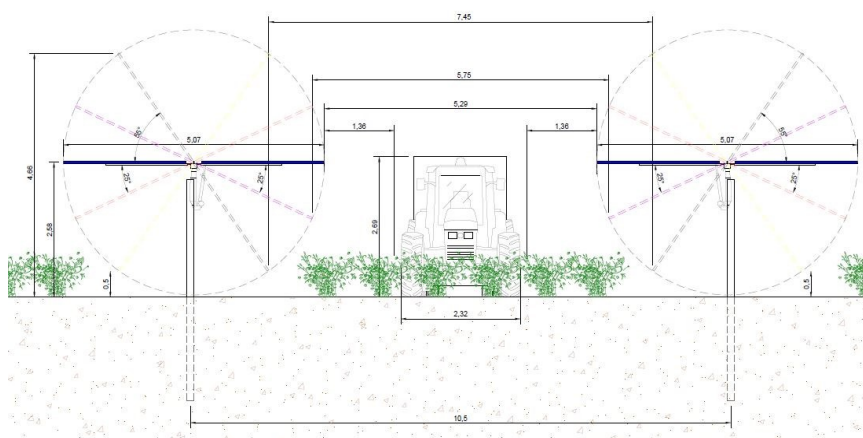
Sezione dell'area dell'impianto con indicazione delle scelte progettuali
